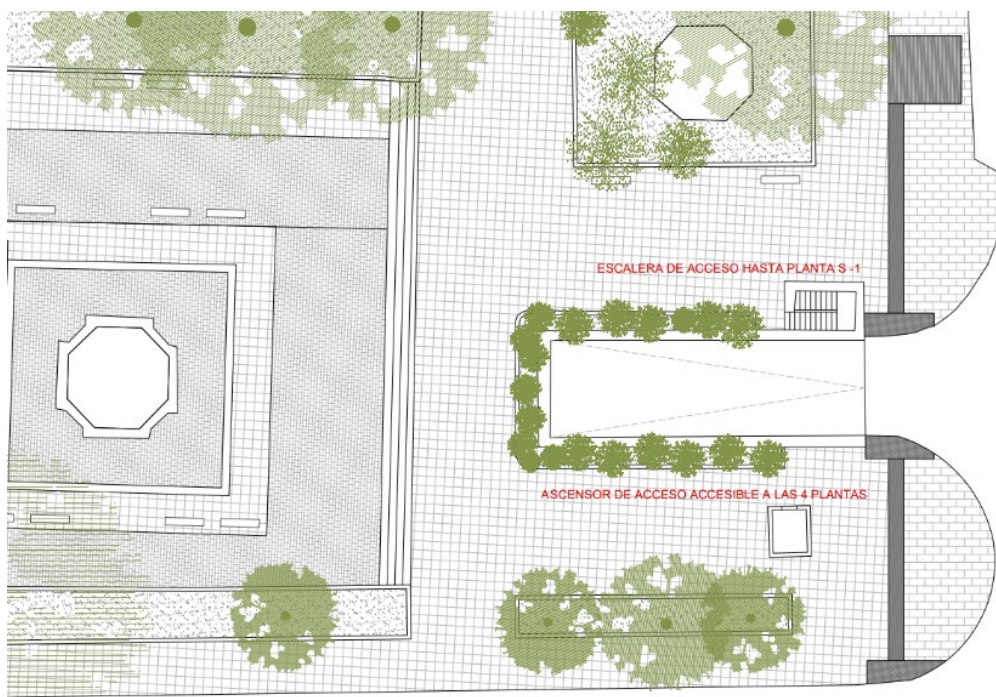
Accesos actuales al aparcamiento– Vista en planta
